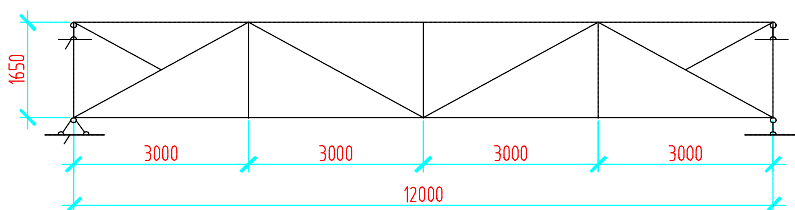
Расчетная схема стропильной фермы _ вариант 3
